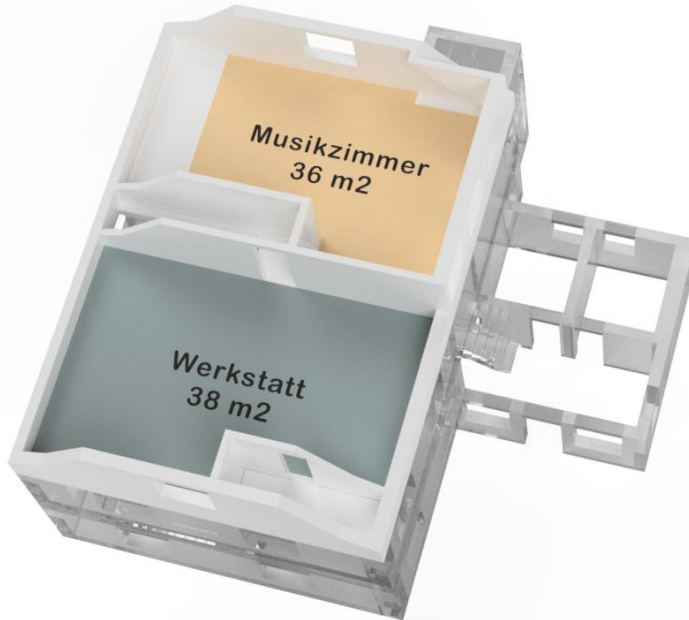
Raumplan Dachgeschoss mit Werkraum und vermietbarer Raum
